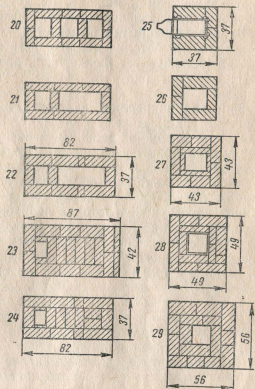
б. Кладка лежажки трехоборотной с 20-го по 29-й ряд.
